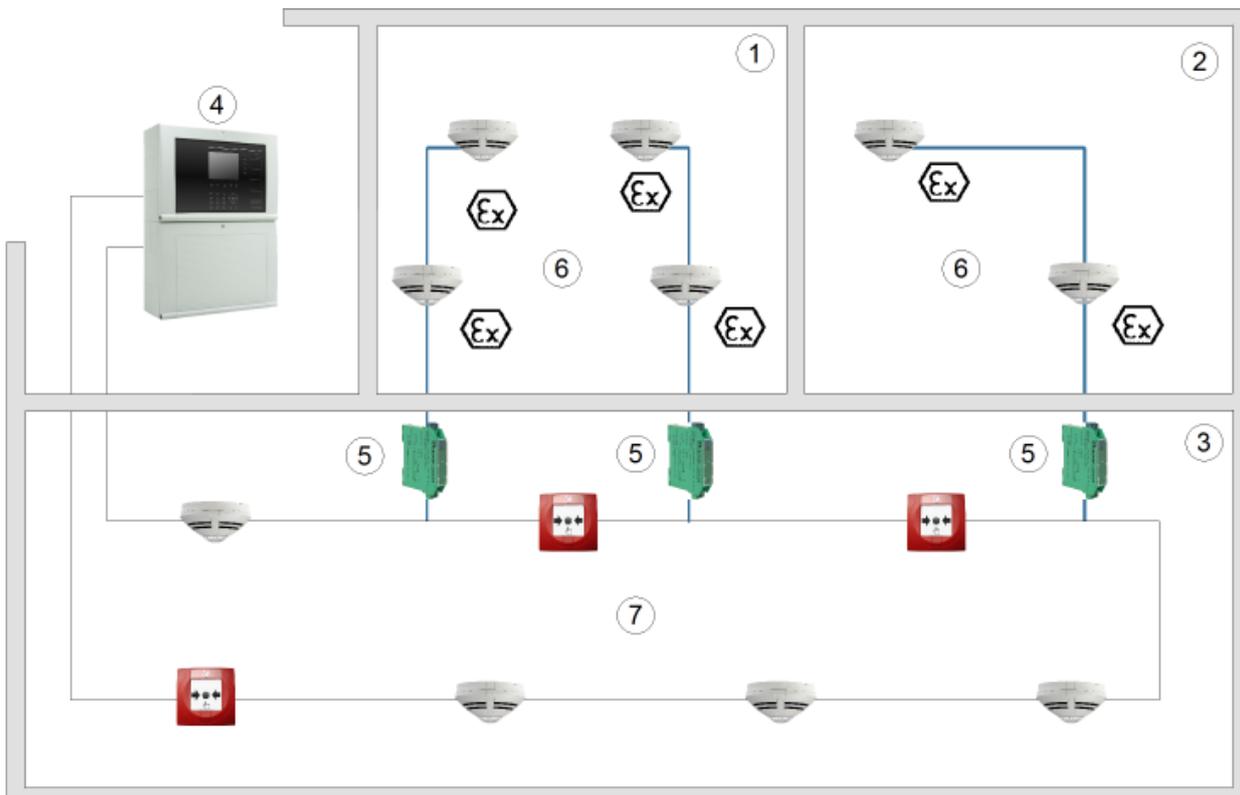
Principio de conexión con barrera de seguridad Ex (Art. no. 804744)
